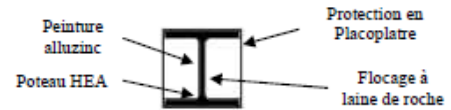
Détail n°02: poteau HEA 300 (1/20)
